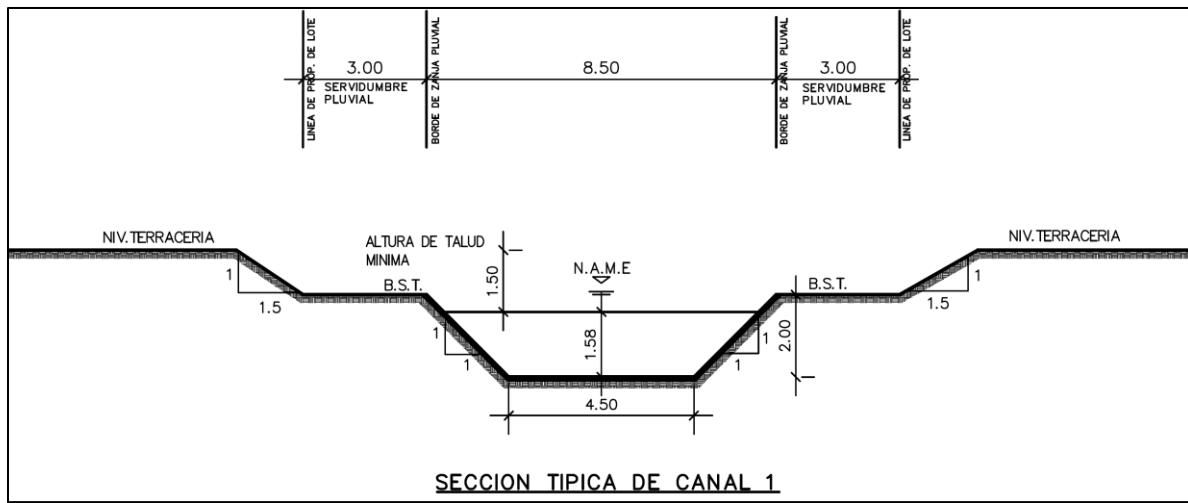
Secciones transversales óptimas conformada en concreto, propuesta para el drenaje pluvial “Sin Nombre 1”
